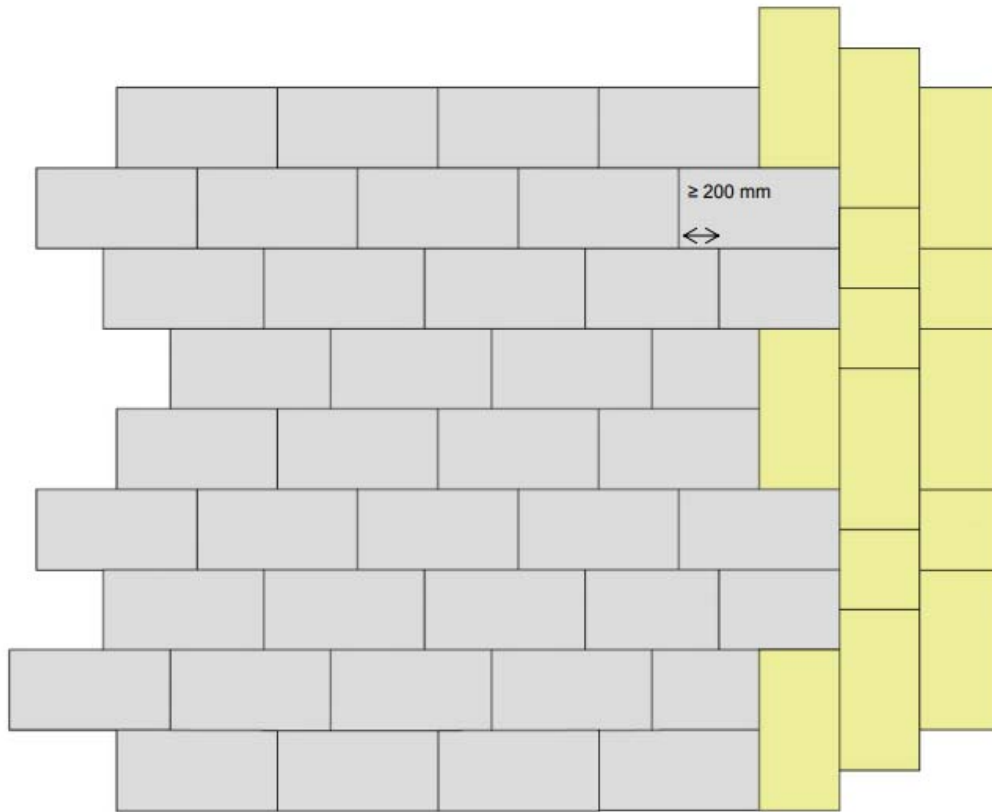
Juxtaposition des poses verticale et horizontale des panneaux isolants sur une même façade
